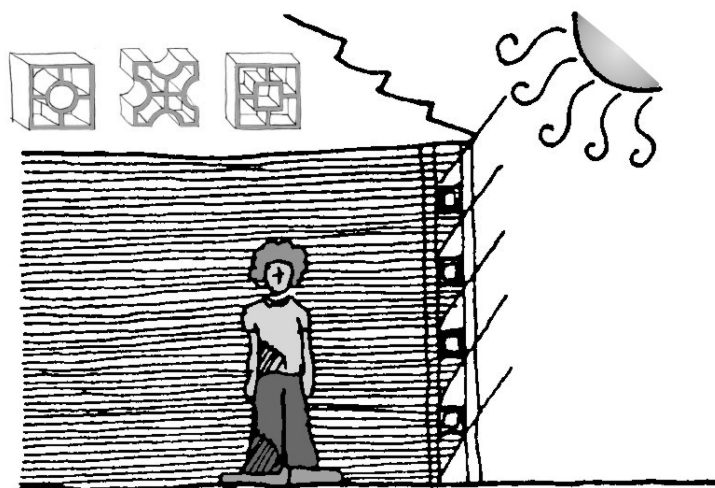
Elemento vazado no muro, direcionando a ventilação.
